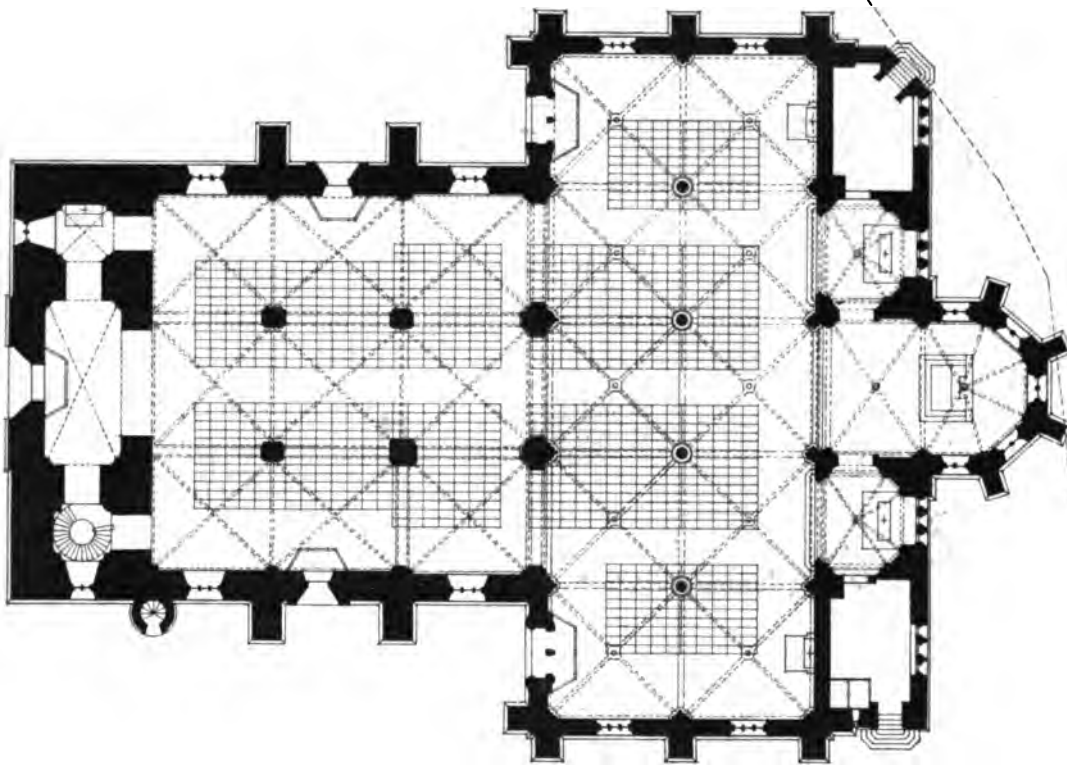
Grundriß der katholischen Stadtpfarrkirche zu Leobschütz nach dem Umbau.
